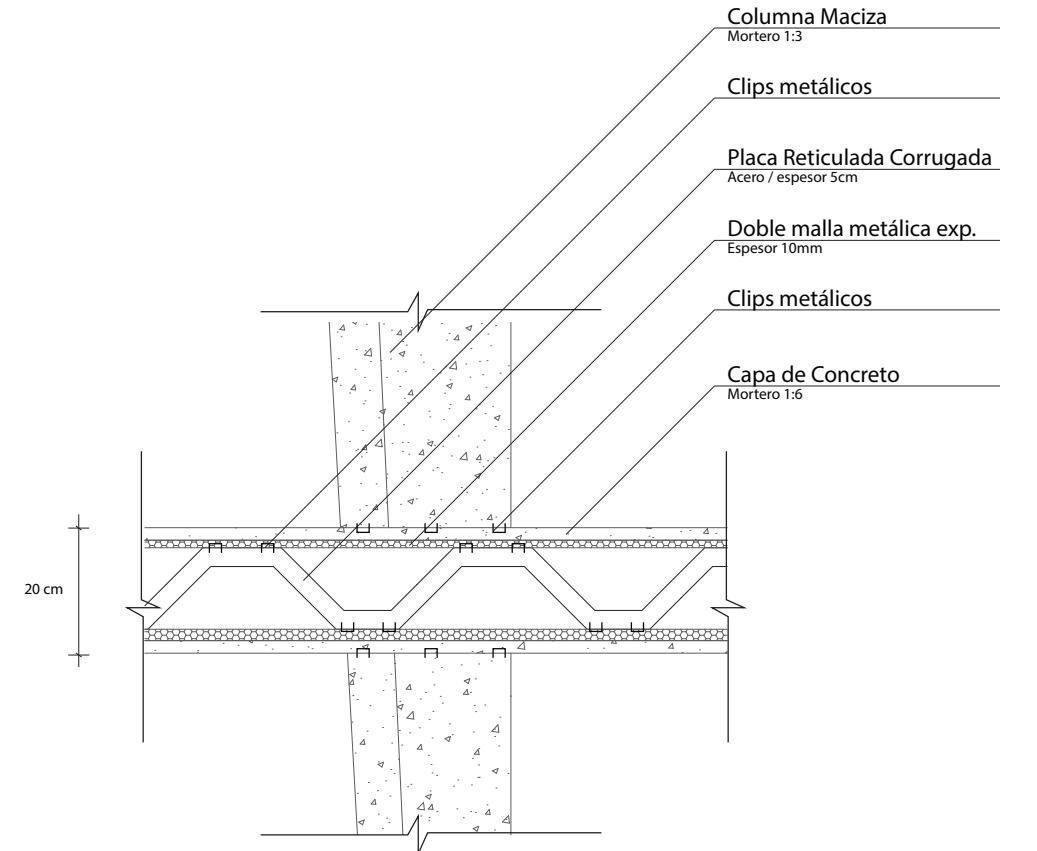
Detalle Constructivo 12 Fuente: sin fuente Elaboración: El Autor
